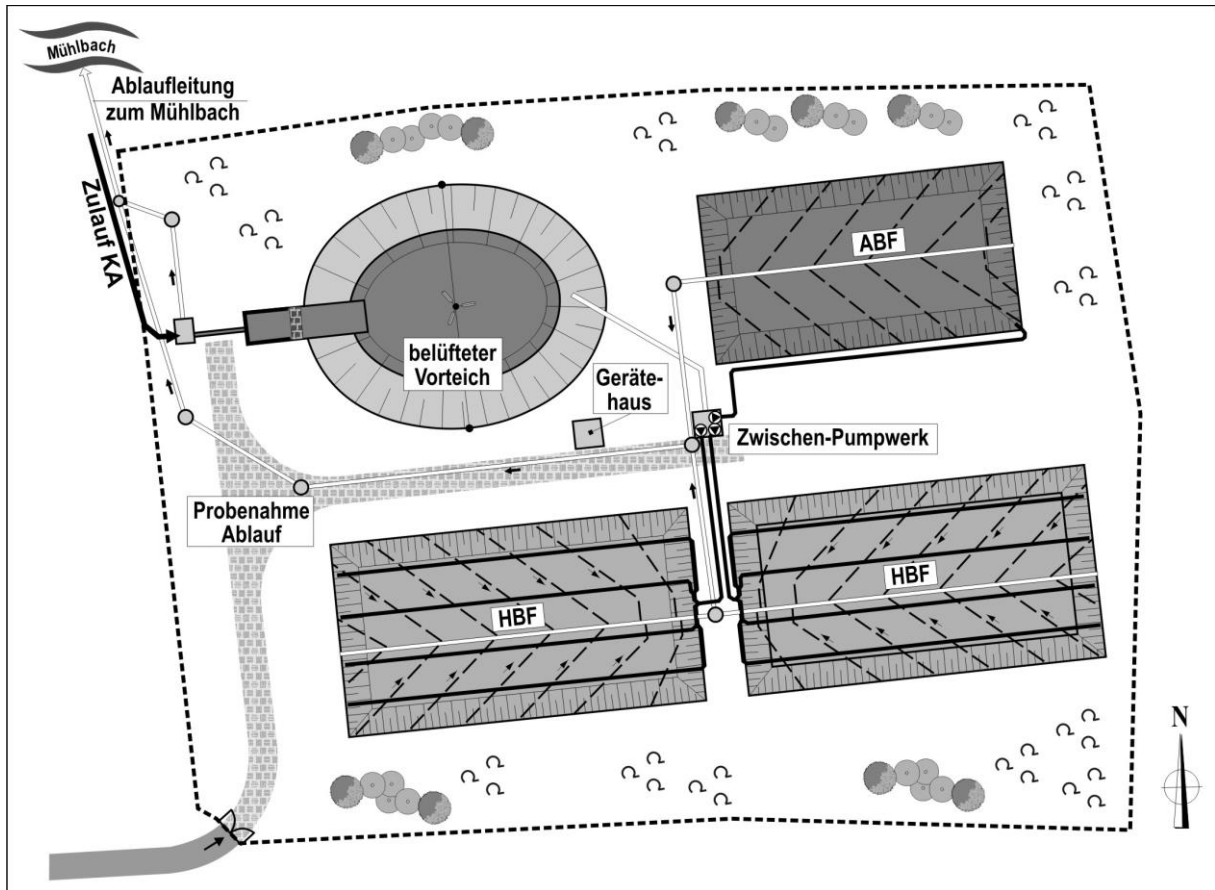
Lageplan zur Kläranlage Medelsheim
